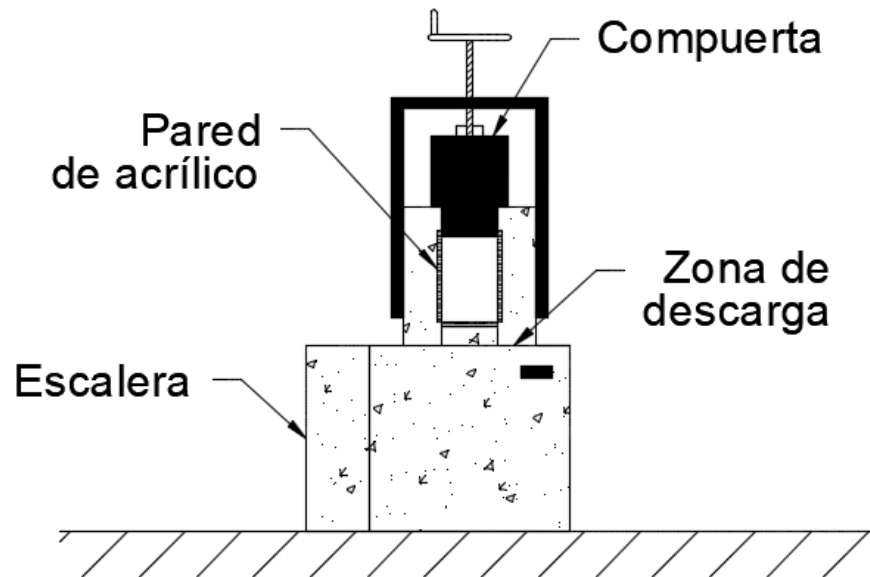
3 Corte transversal del canal horizontal del laboratorio de la Facultad de Ingeniería, UNAM.
